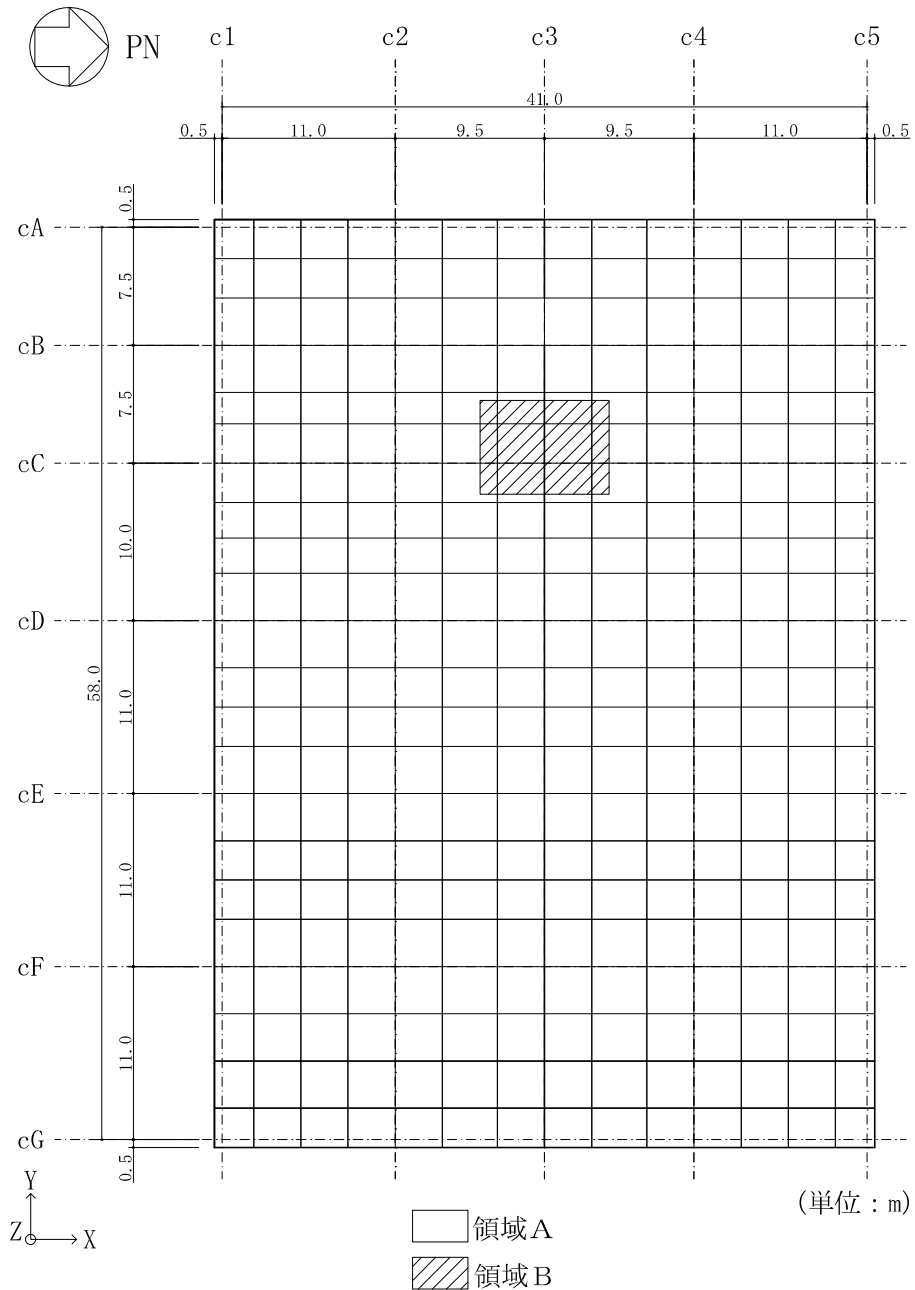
基礎スラブの配筋領域図 (NS 方向, 下ば筋)
